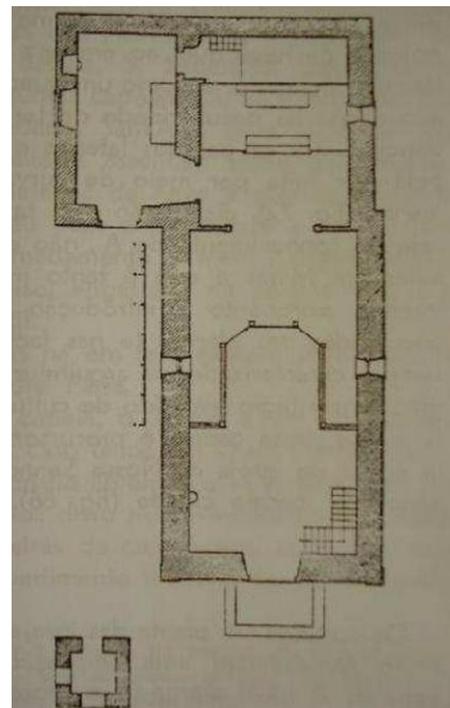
Planta Baixa. Fonte: Paulo F. Santos 1951
